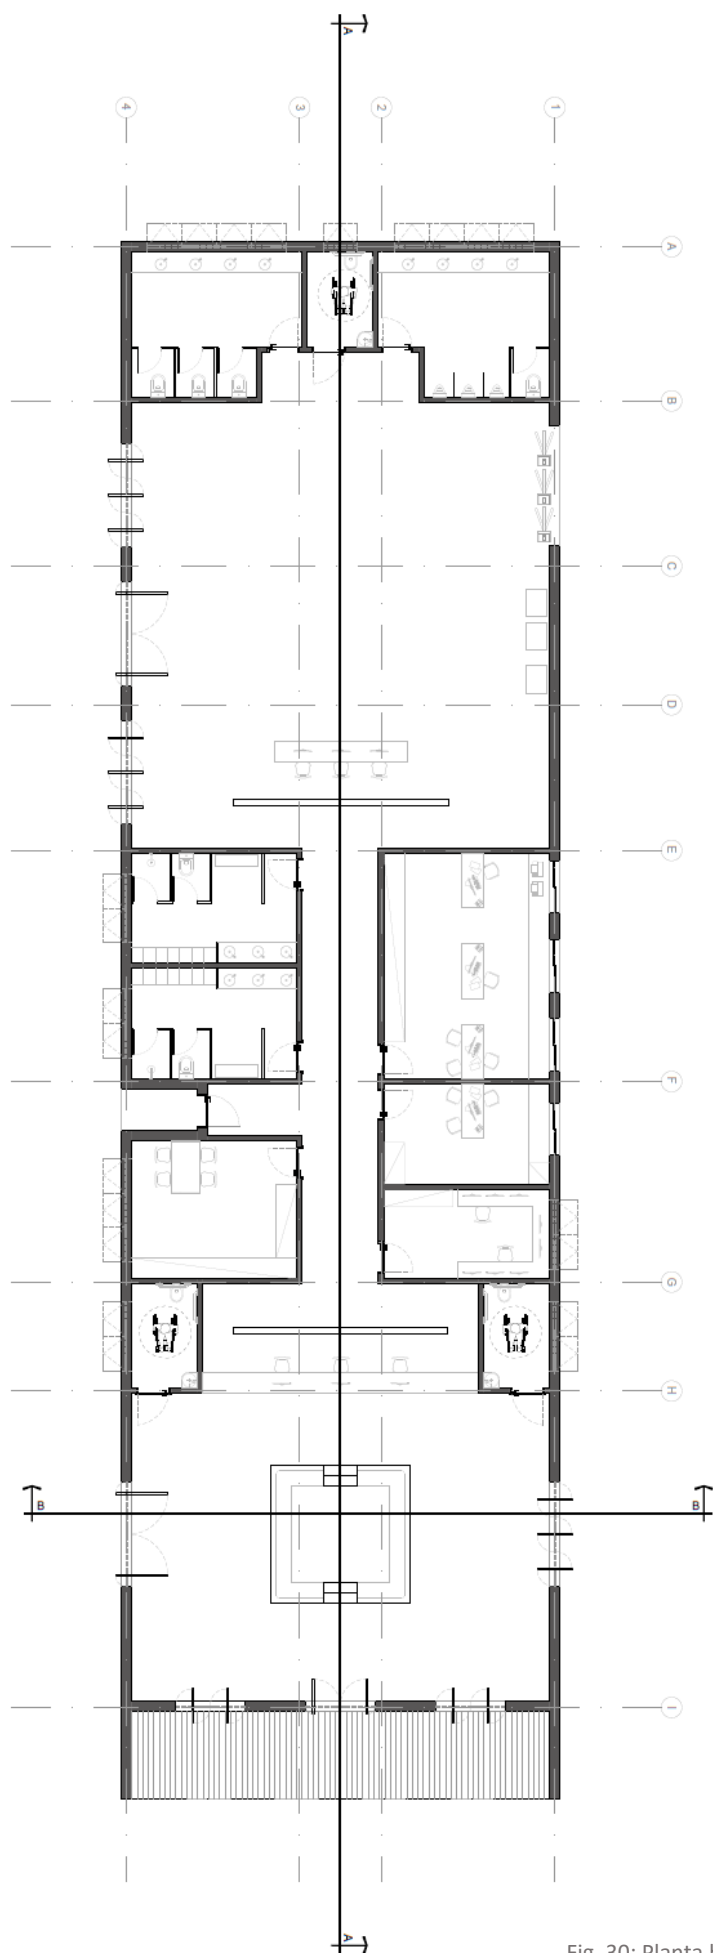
Planta baixa do equipamento 3 (Recepção)
